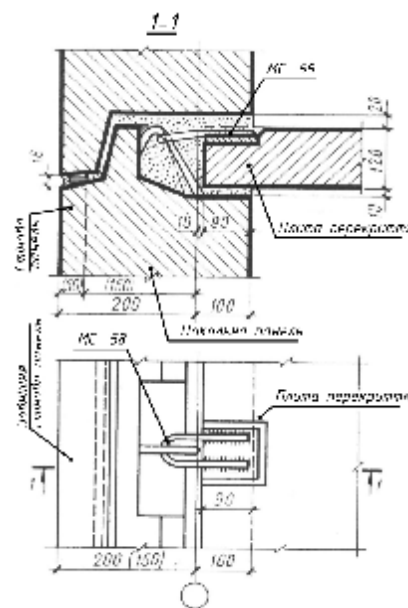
Схематичне зображення примикання плити перекриття з стіною панеллю.
